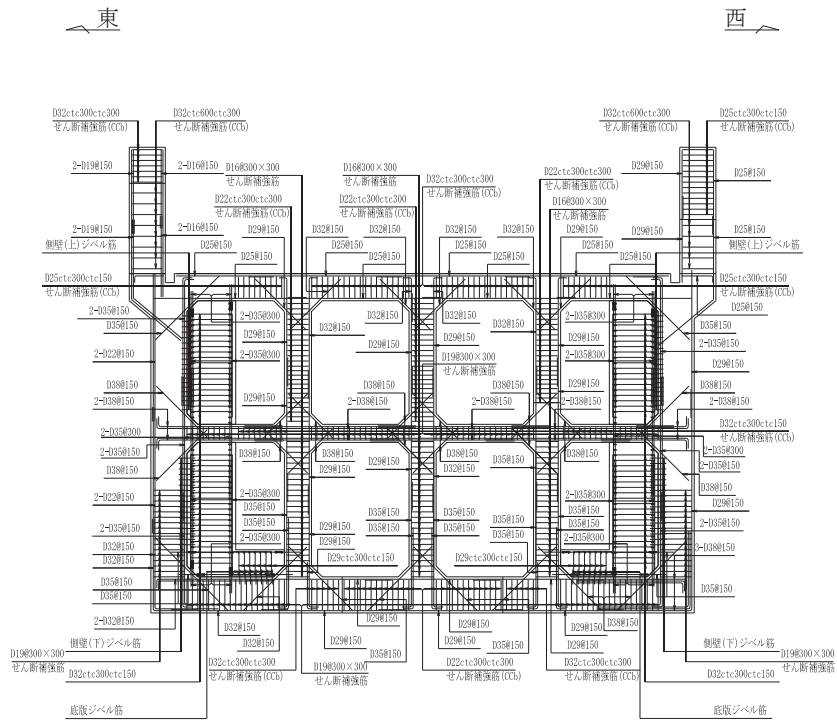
海水ポンプ室概略配筋図 (A-A 断面)
